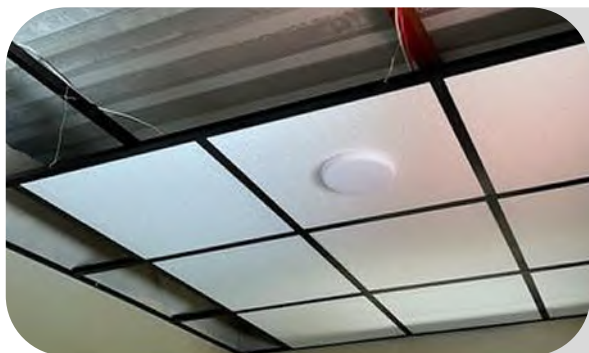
Falso plafón sobre cubierta de lámina, Construcciones Flores, 2023.
